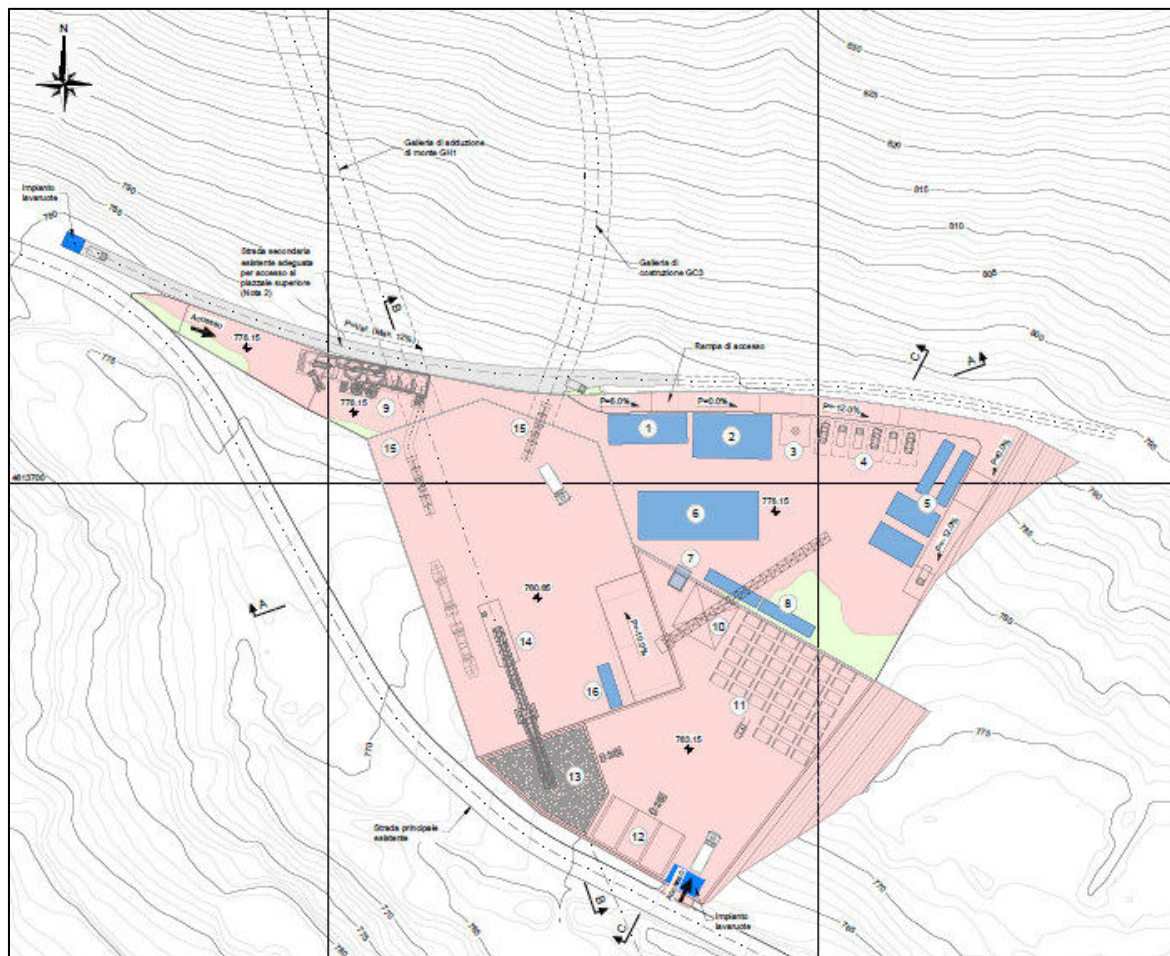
Ambito Pizzone - Area di cantiere CO.04 – Zona di lancio TBM di monte
